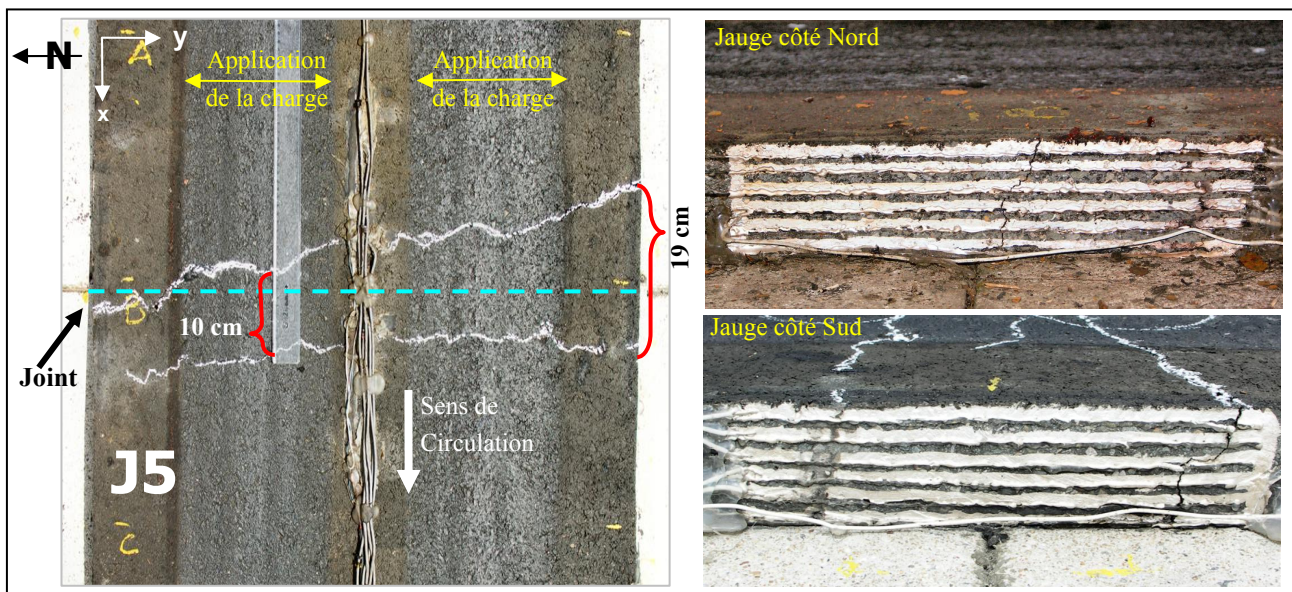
fissuration réfléctive double survenue sur le joint 5
